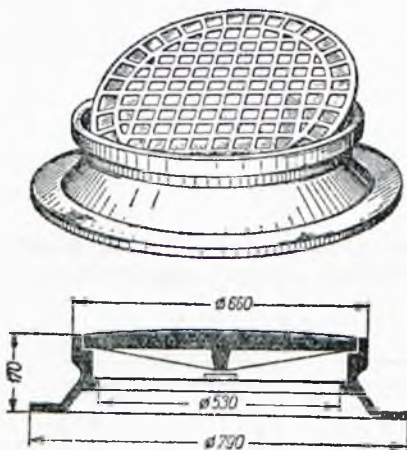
Skrzynka włazowa typu ciężkiego z pokrywą nabijaną drewnem dębowym
